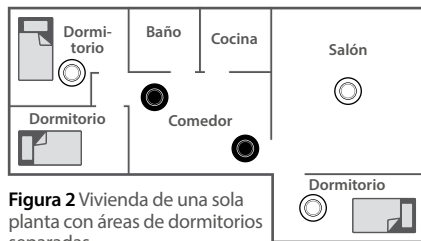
Vivienda de una sola planta con áreas de dormitorios separadas
